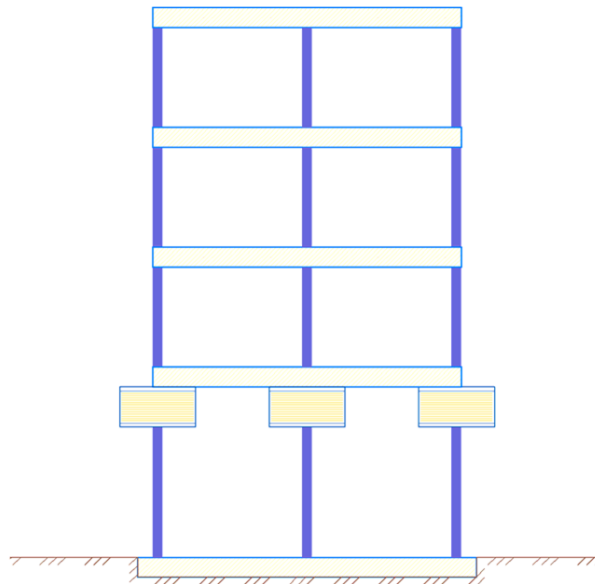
Ubicación de aisladores sísmicos en la parte superior de las columnas de la primera planta.
